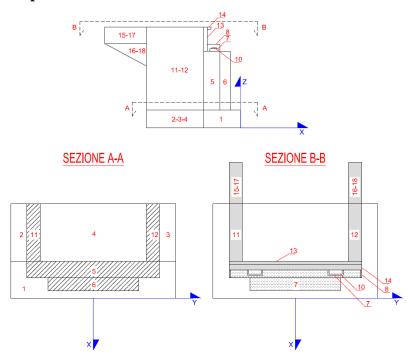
Schema qualitativo della geometria della spalla
